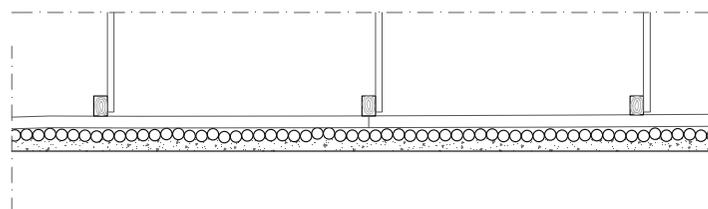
Detalle constructivo falsotecho con estructura de cañizo y yeso.
